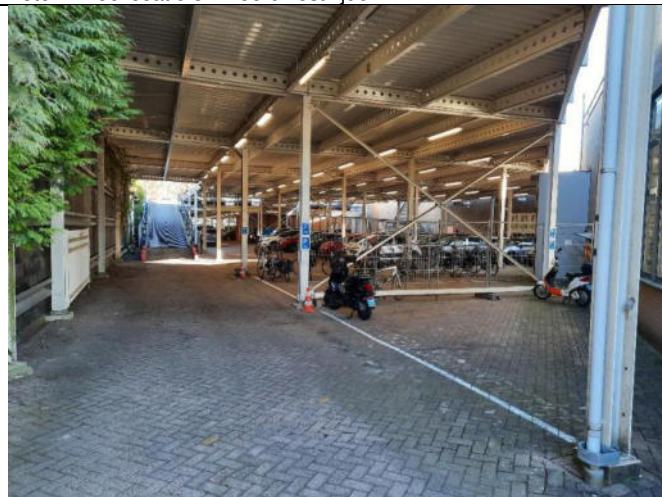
Deellocatie 3 - Westzijde met oprit parkeerdek
